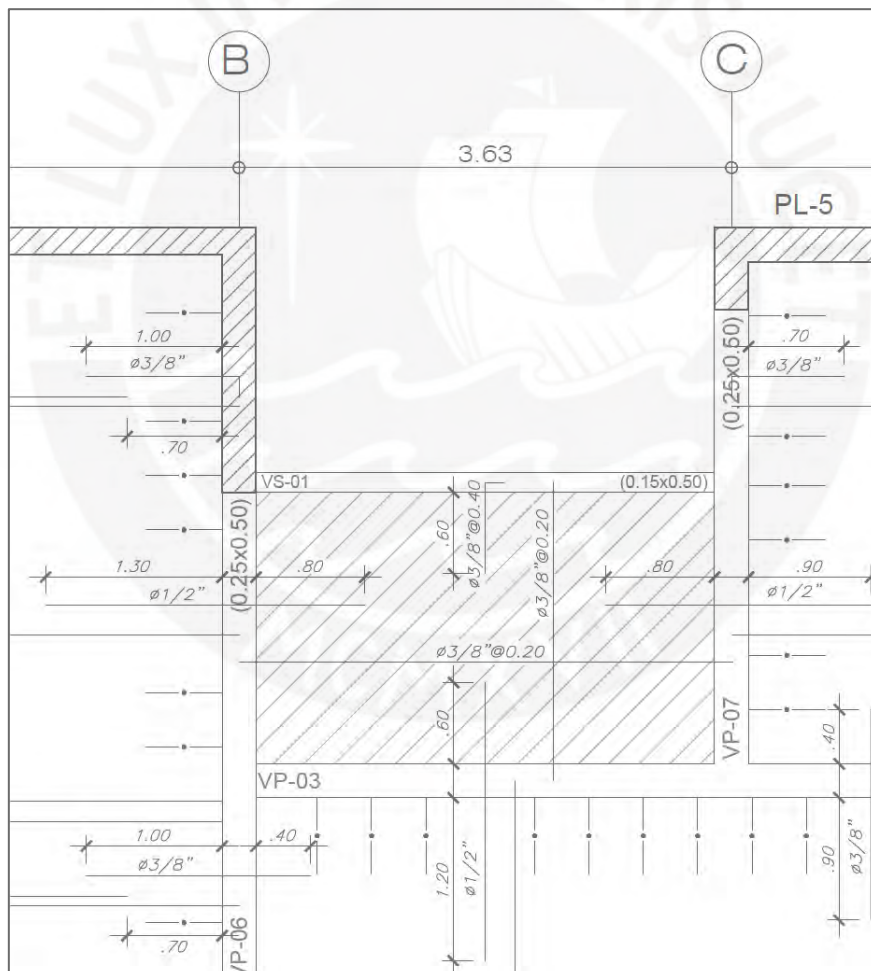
Distribución final del refuerzo colocado en la losa maciza analizada
